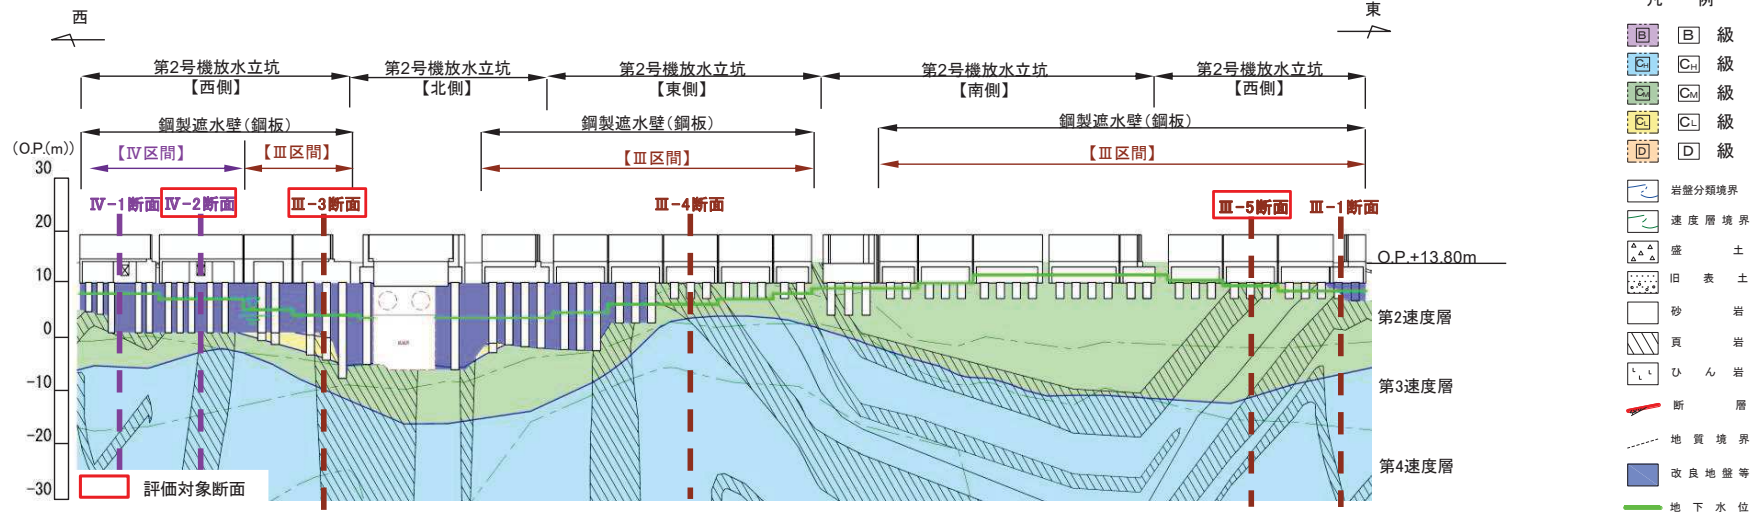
(2) 評価対象断面の地質縦断図 (第2号機放水立坑)
